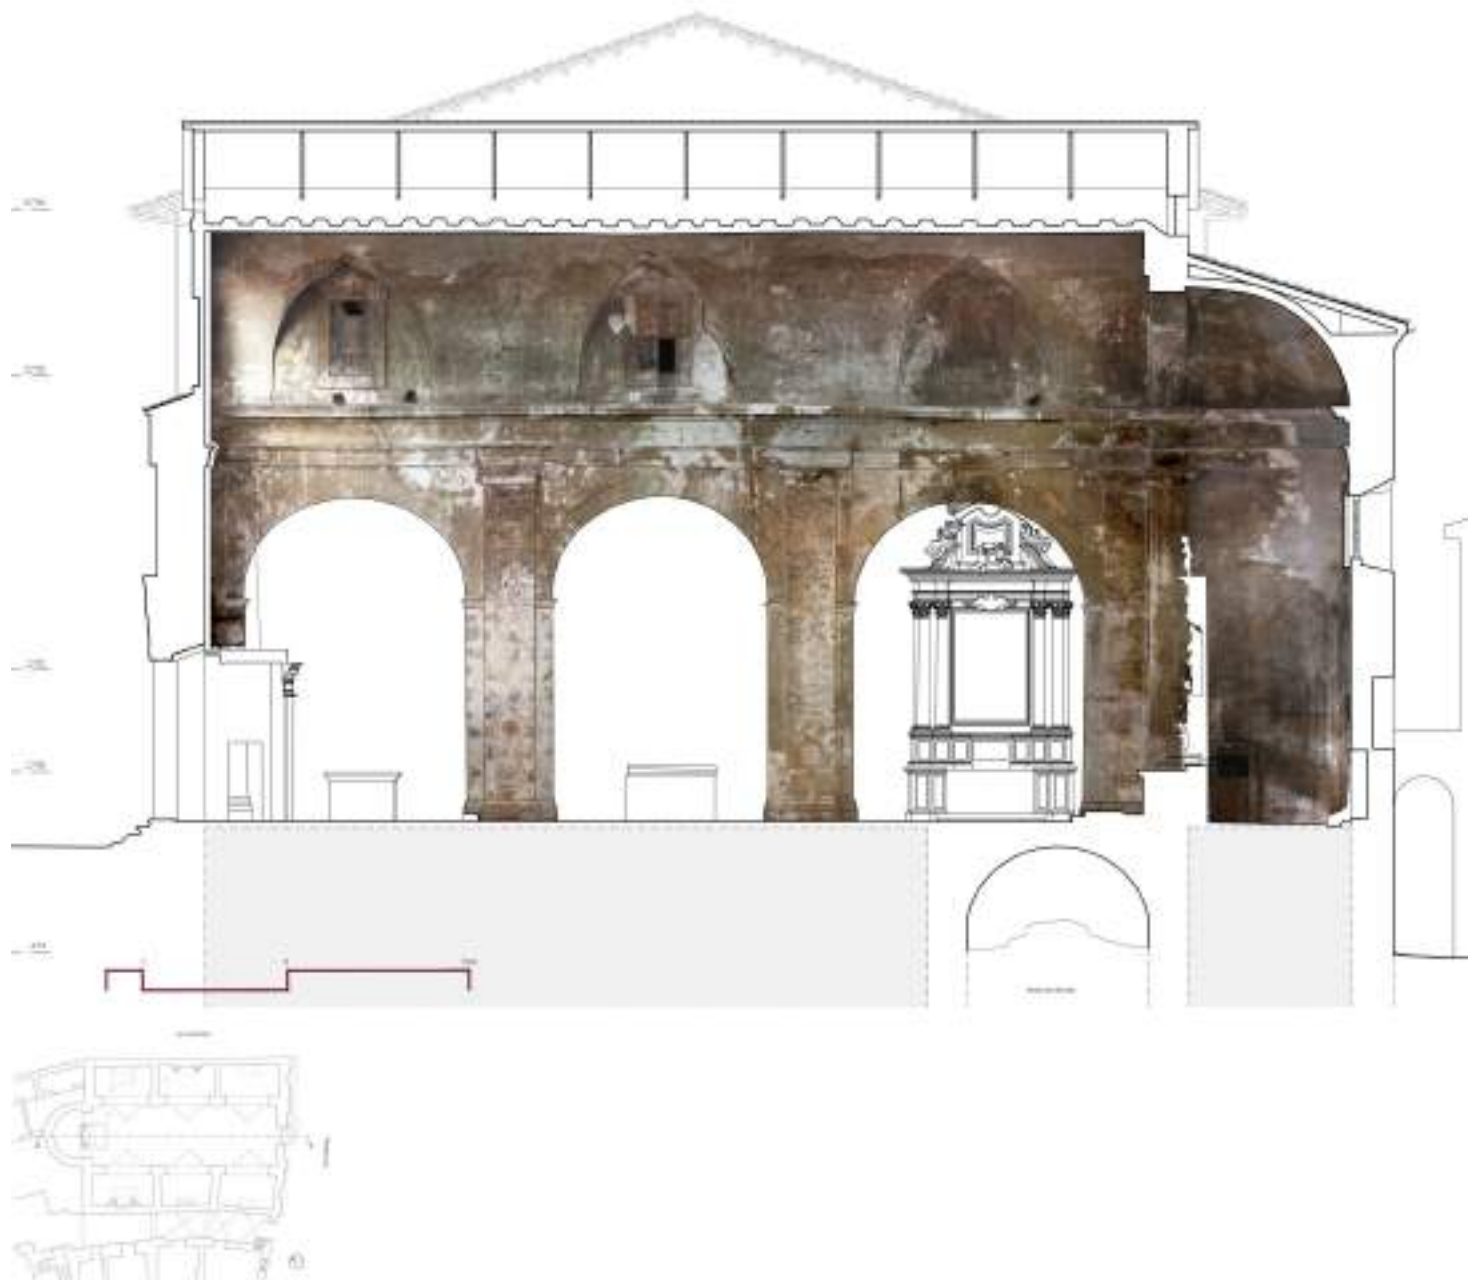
/ Sezione longitudinale BB' con ortofoto.
